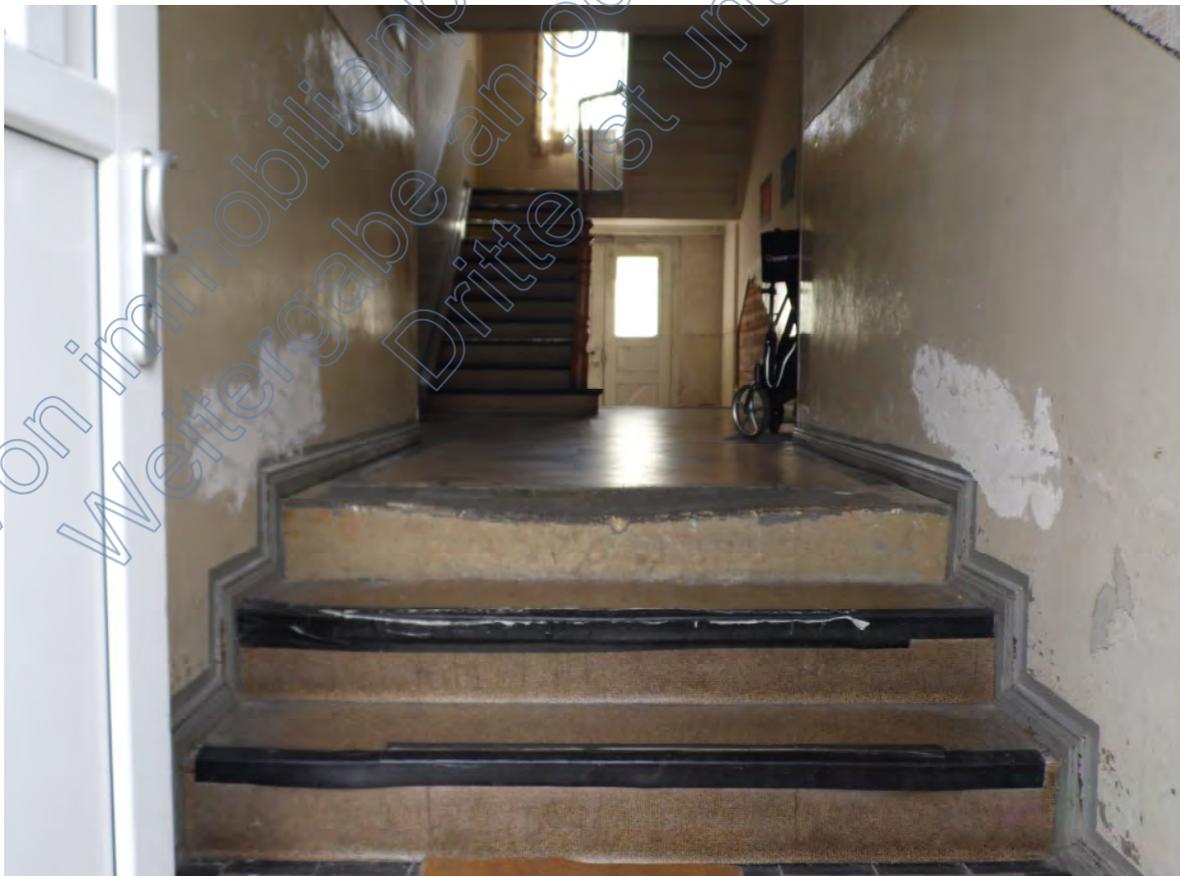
Ausschnitt – Eingangssituation / mit Zugangstreppe Richtung Hauseingangsflur mit Treppe zum OG (Wohnhaus mit sechs Wohneinheiten EG).
